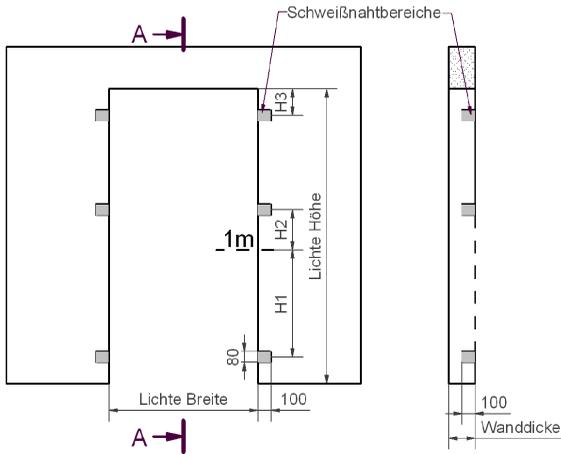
Maßskizze der Befestigungsbereiche für Schweißnähte
